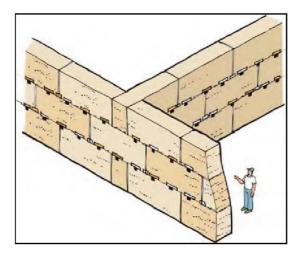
Encuentro entre muro perimetral y muro divisorio Fuente: (AIS, 2010)
